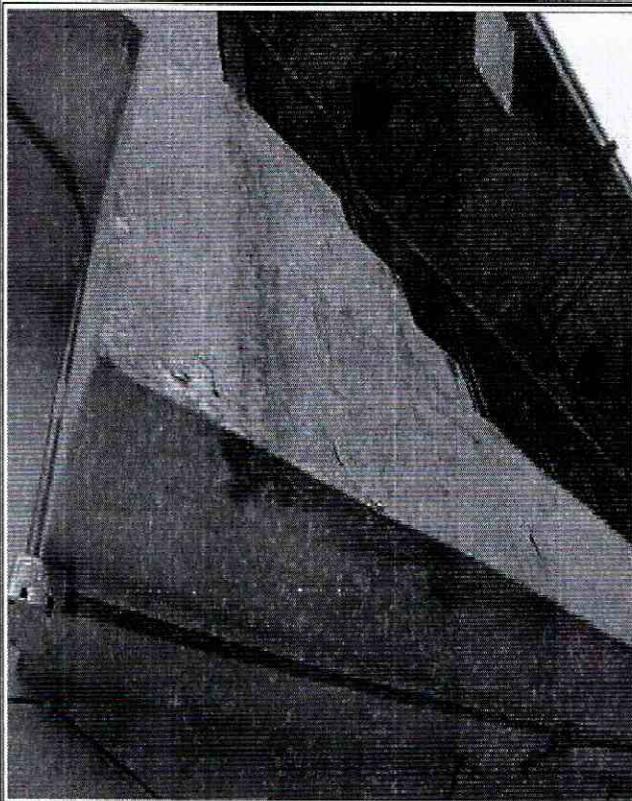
Humedades en muros divisorios y de cerramiento perimetral edificación Sede A Sección Primaria
